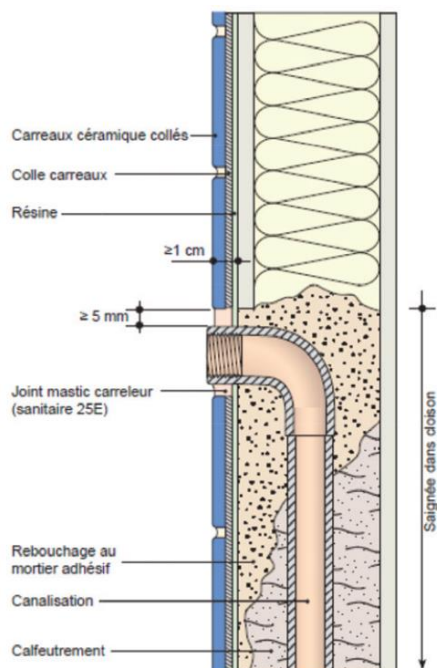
Traitement d'une canalisation encastrée (sans fourreau) en paroi verticale ; exemple d'une cloison en plaques de parement en plâtre.
